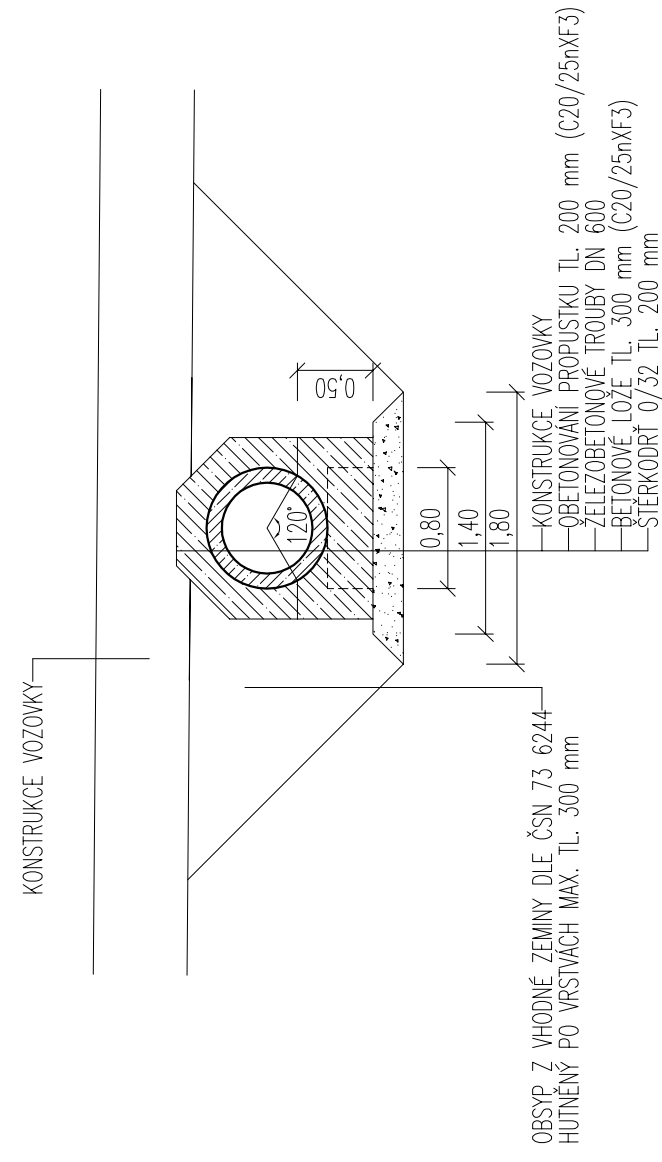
DETAIL ULOŽENÍ TRUB PROPUSTKŮ
